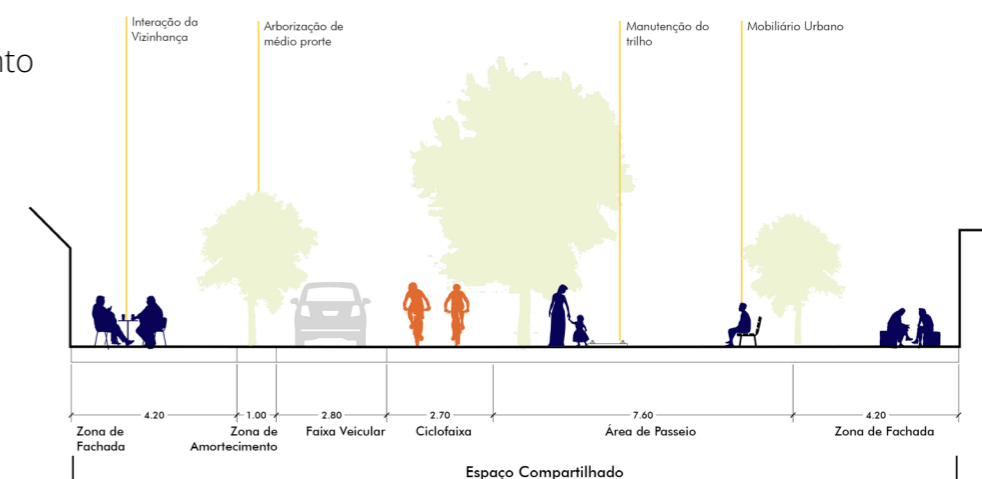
Corte de Rua AA proposto para o parque, em área com estacionamento. Fonte: Autor
